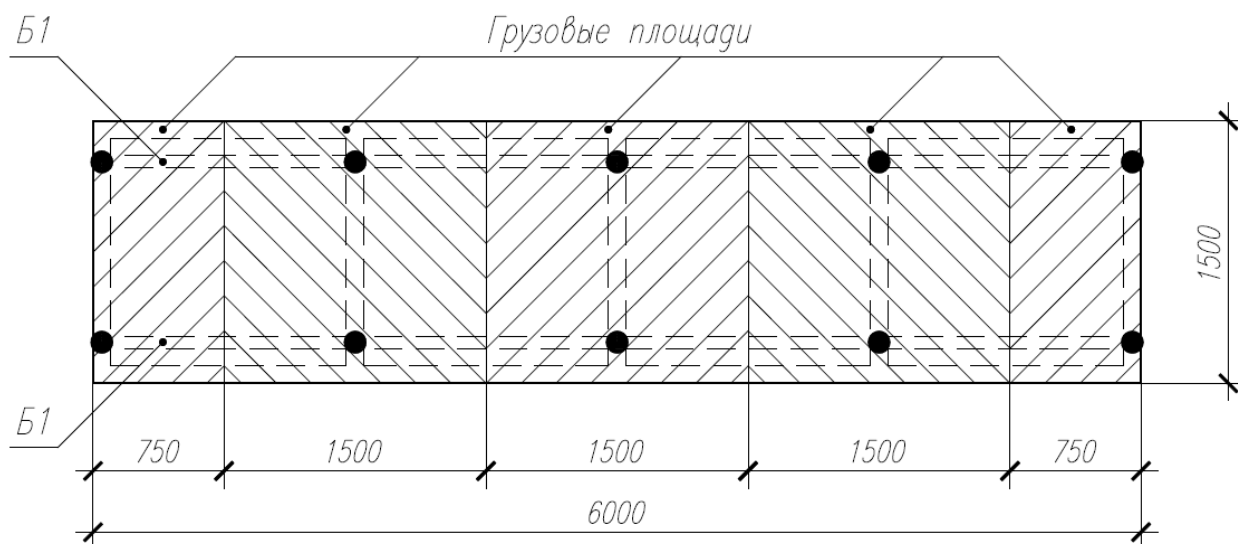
Схема распределения нагрузки на балки усиления Б1
